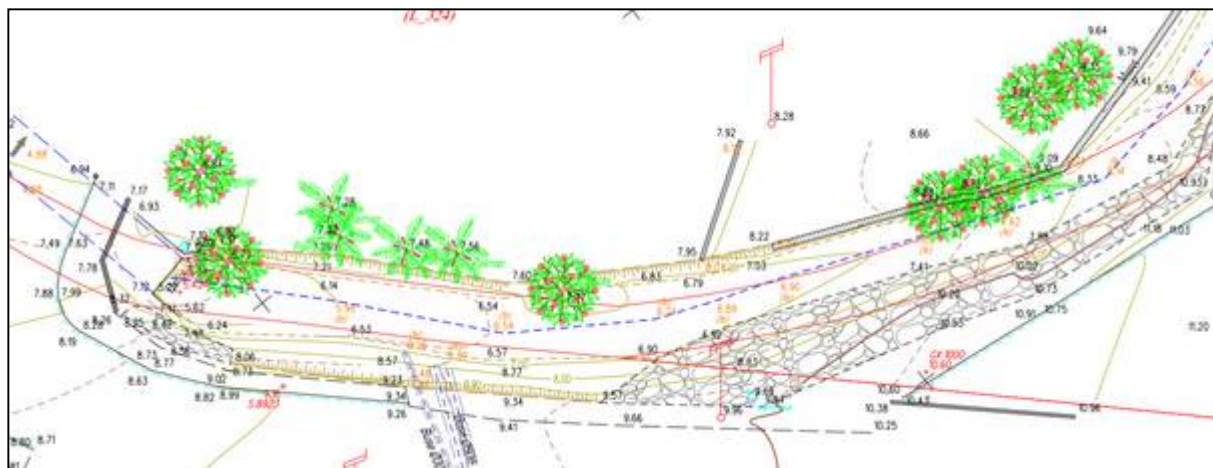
Section en amont de l'ouvrage de la RDC, planche 3, topographie de 2015
